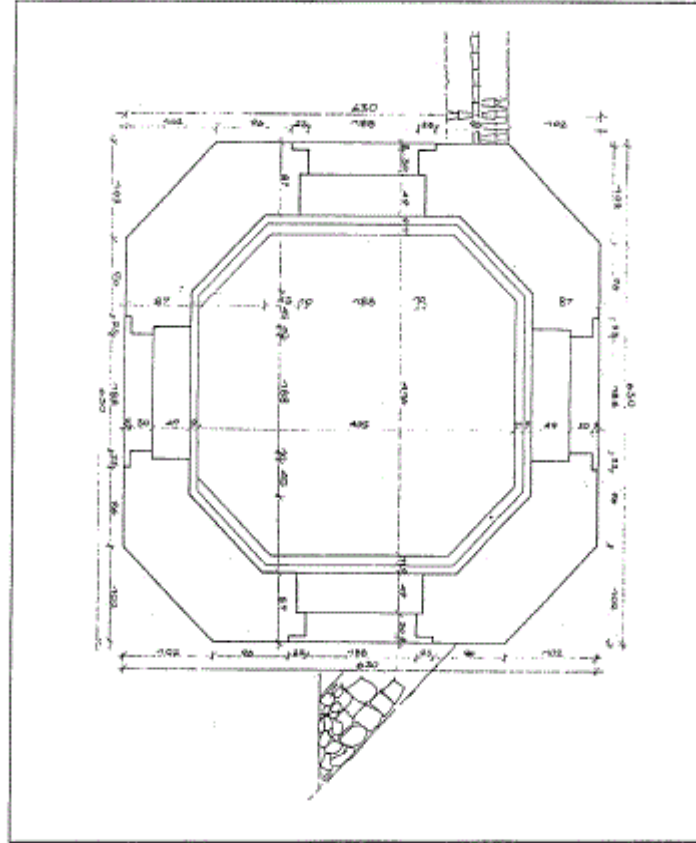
مسقط أفقي لثربة خسرو باشا بإستانبول (عن: عبد الحافظ).
